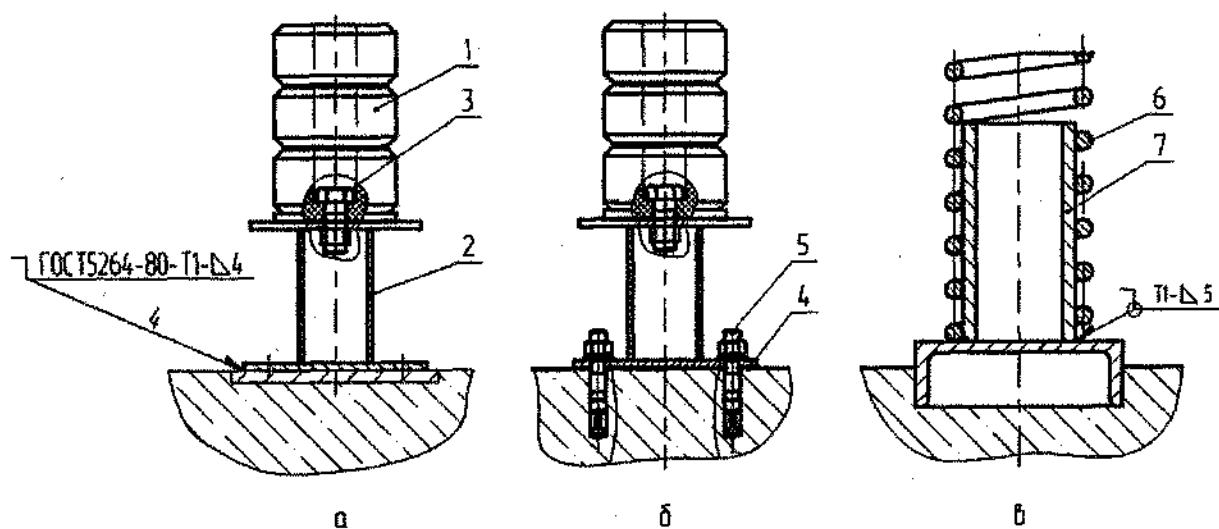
Схема крепления буфера в приемке а) сваркой б) анкерами в) пружинный буфер противовеса: 1 - Буфер полимерный; 2 - опора; 3 - болт; 4 - прокладка регулировочная; 5 - распорный анкер; 6 - пружина буфера; 7 - стакан (направляющая пружины).
